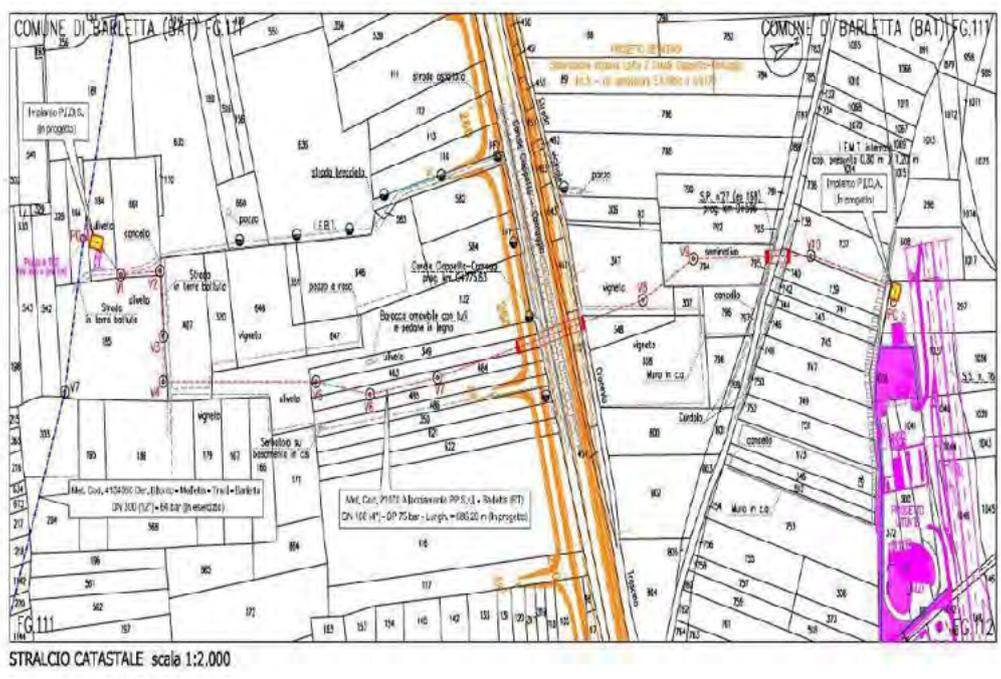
Stralcio progetto SNAM Rete Gas S.p.A
